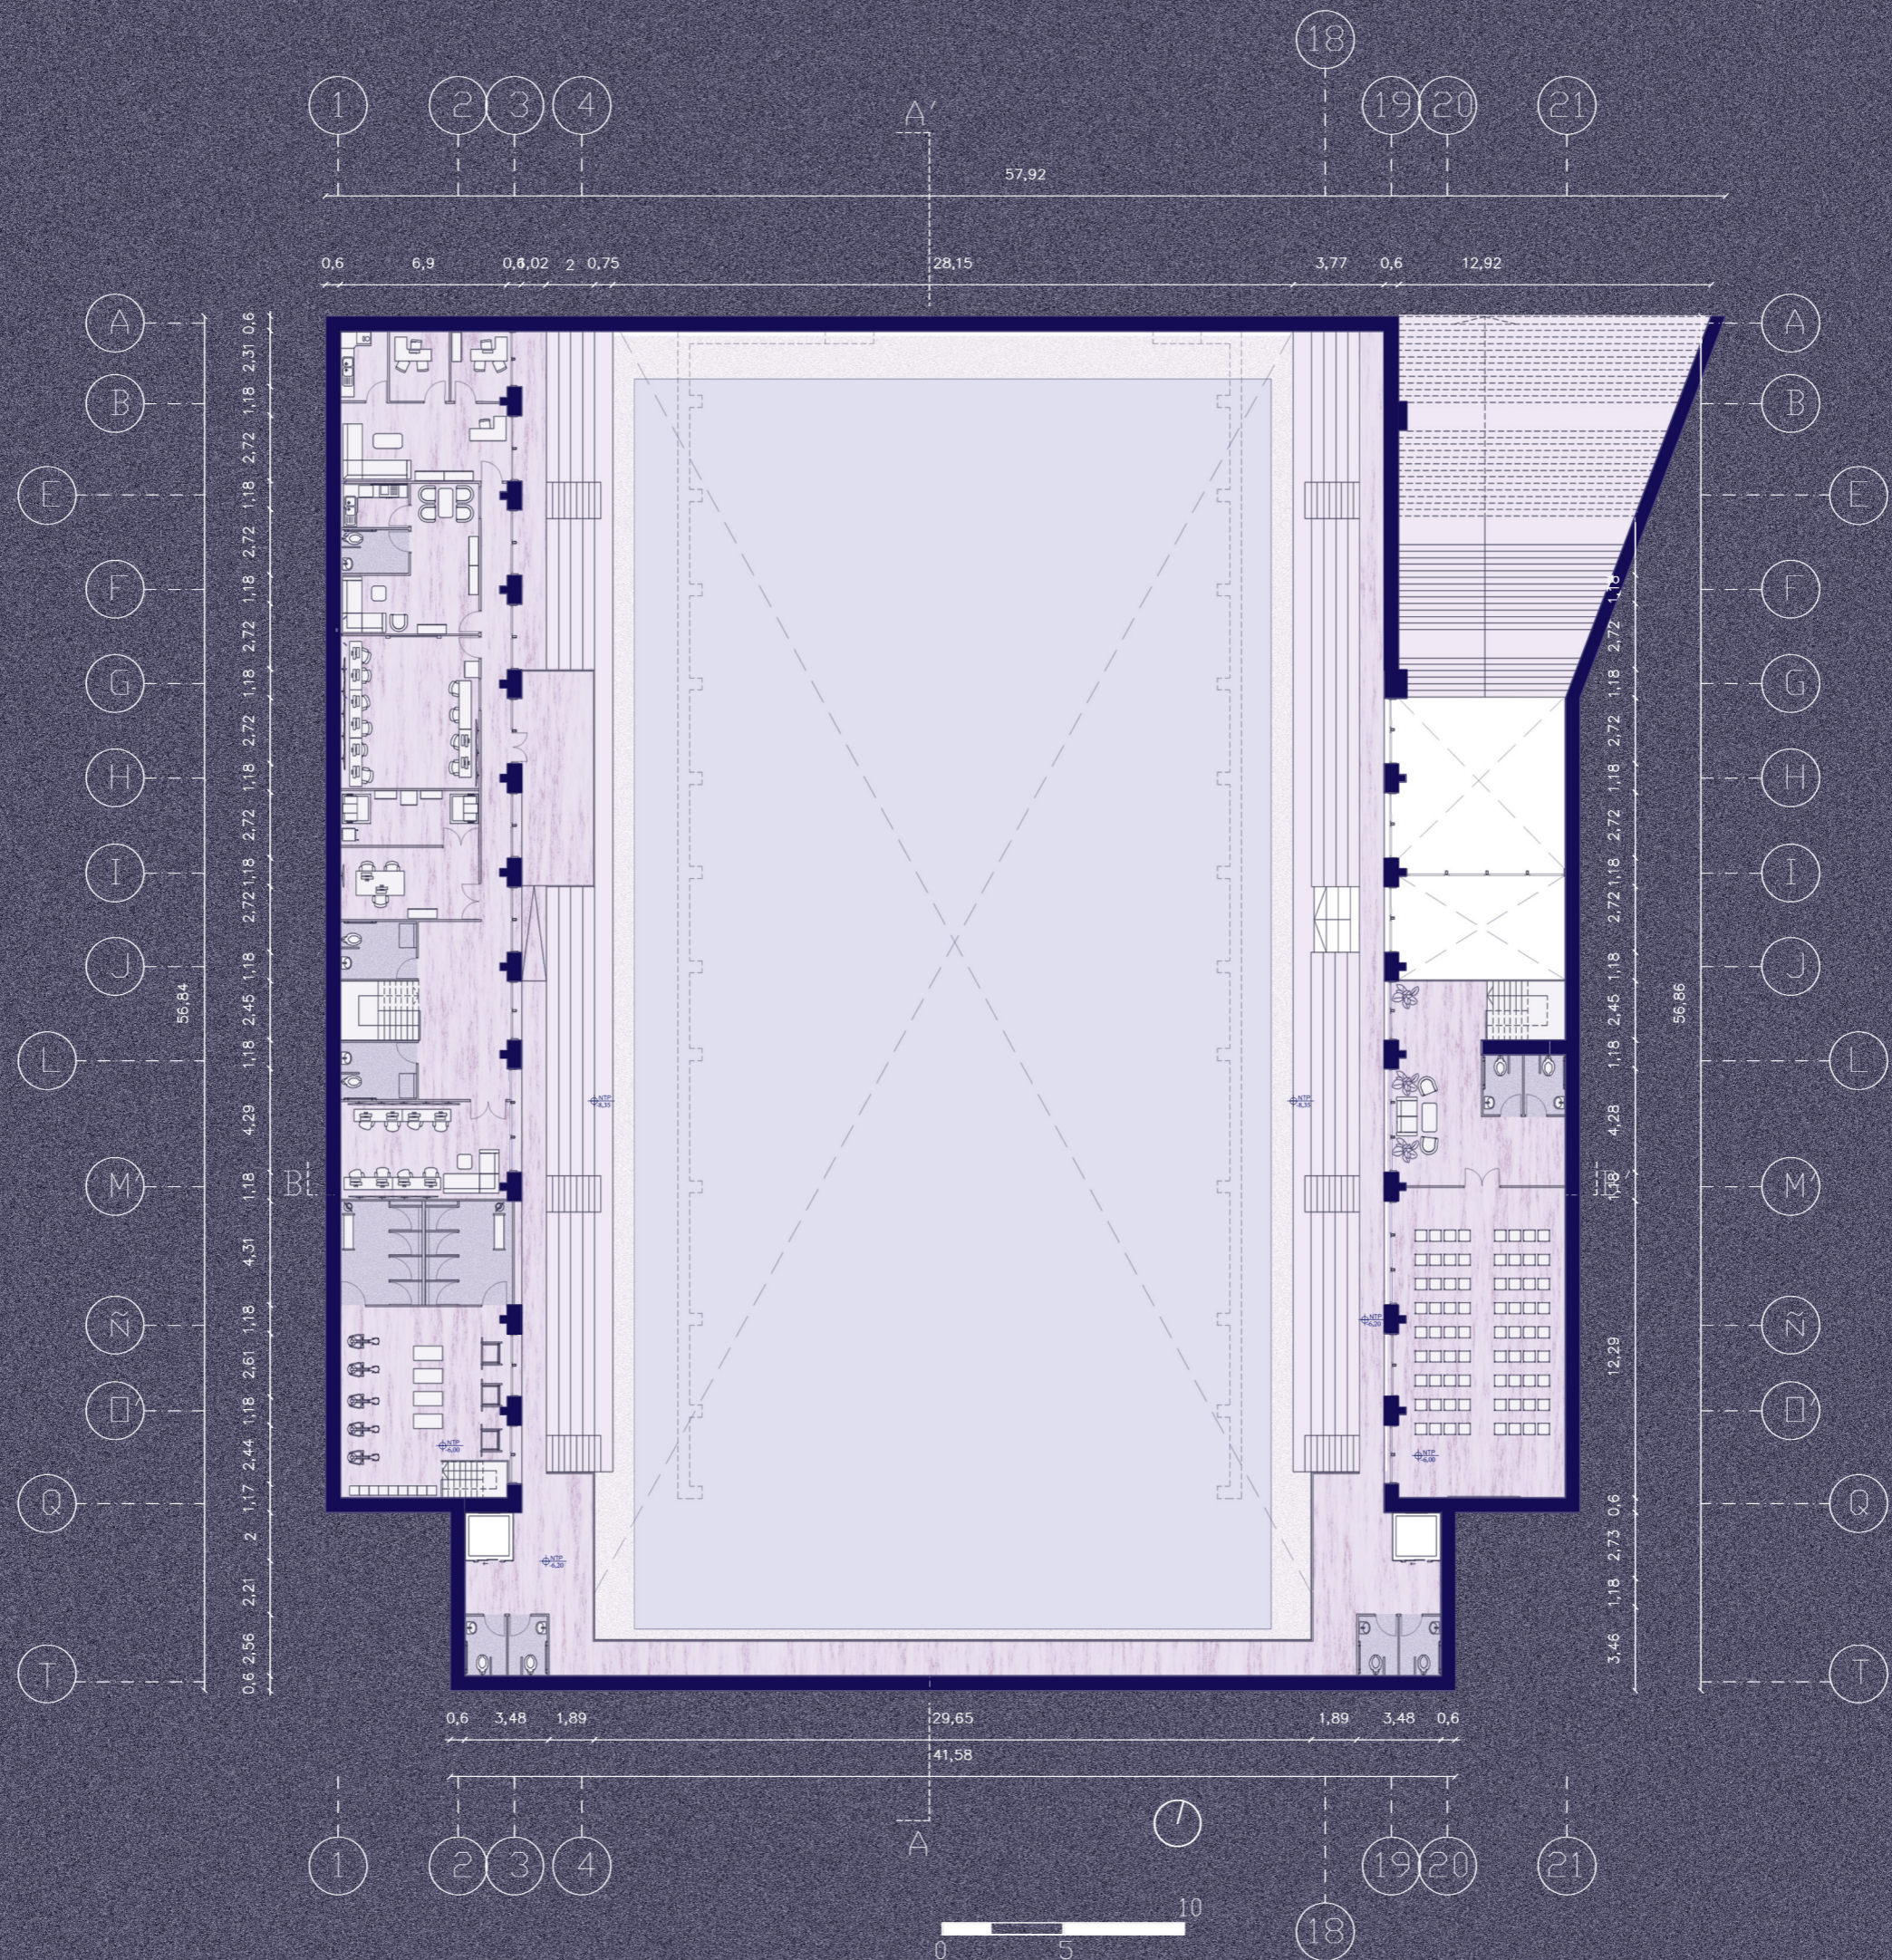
Planta N°-1, nivel -6.0. Fuente: Elaboración propia
